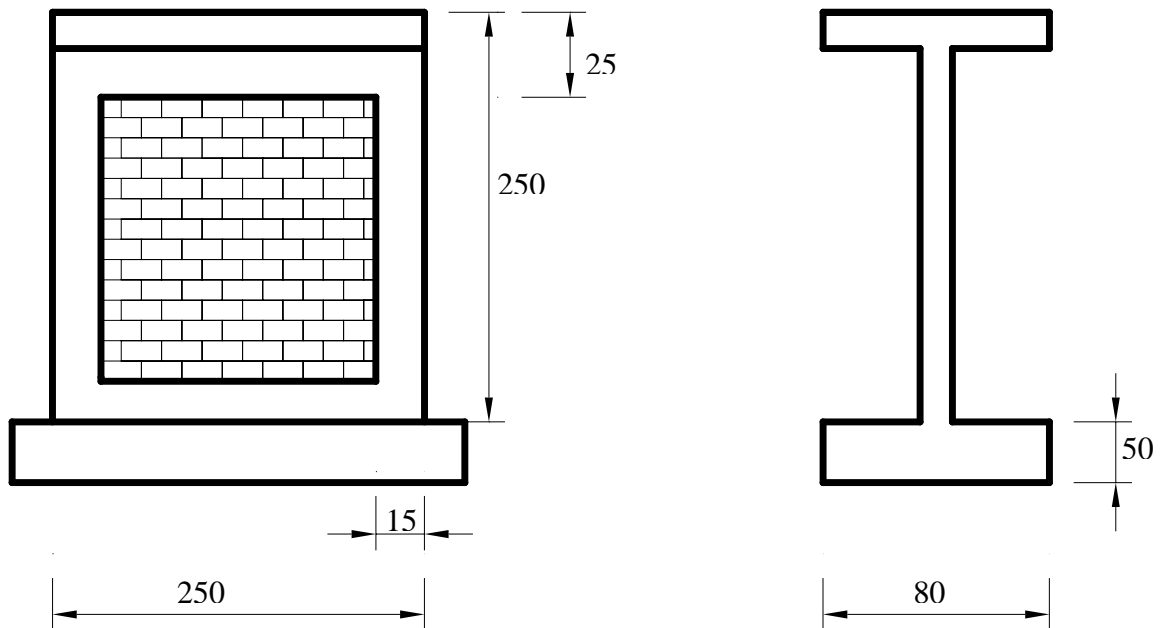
Dimensión de muro de mampostería confinada (modelo experimental) de (Aguilar, 1996).
